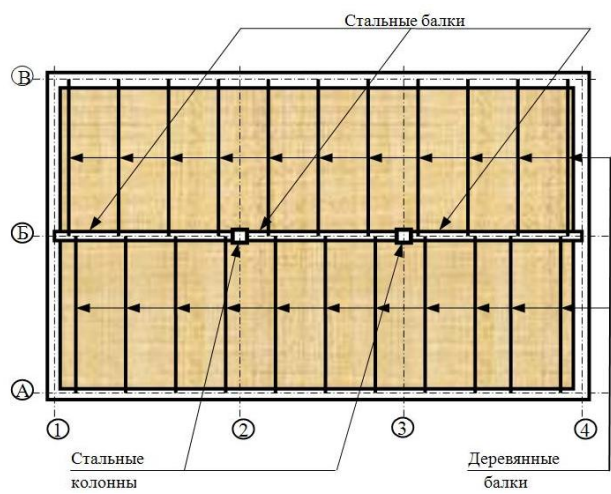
Схема раскладки элементов перекрытия по стальным и деревянным балкам
